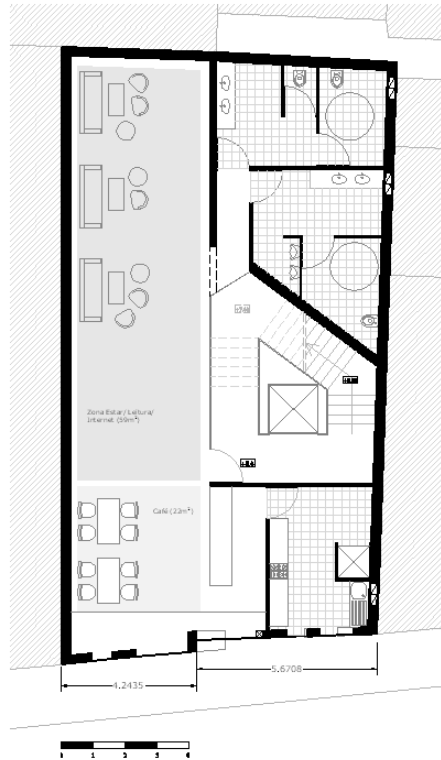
Planta Piso 1, escala 1/100 Autocad
